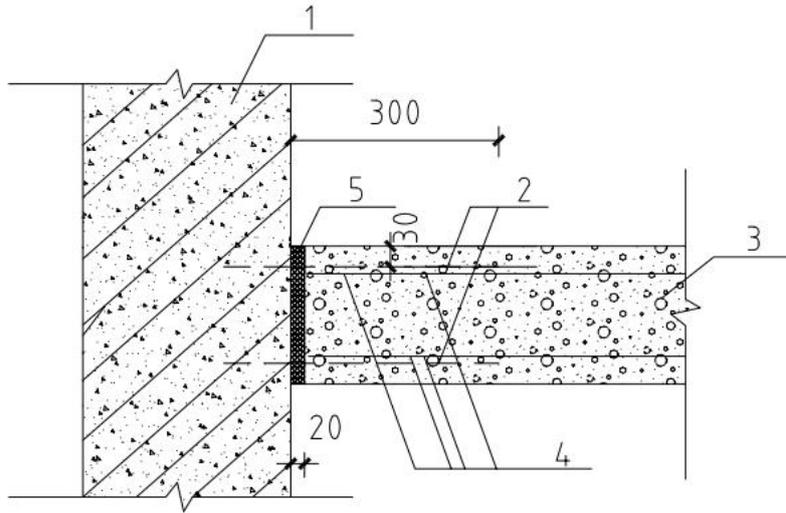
配双层钢丝焊接网的泡沫混凝土墙体与柱、墙连接示意
